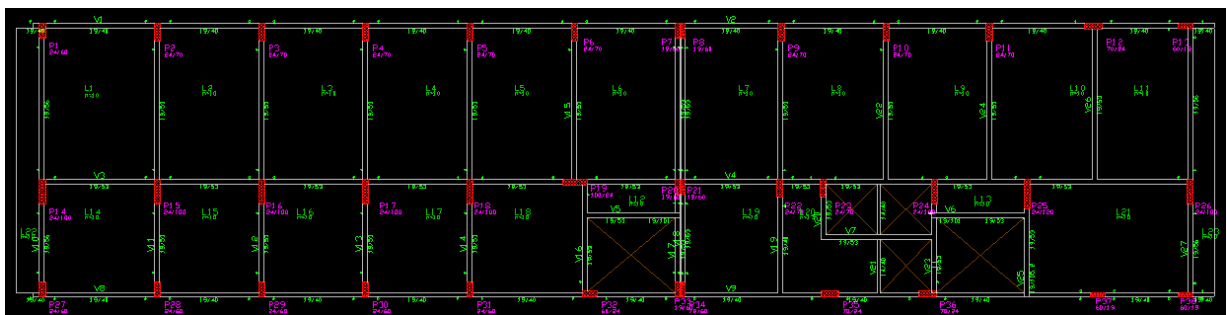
Pavimento tipo com lajes, vigas e pilares pré-dimensionados no modelador do TQS (Fonte: Autor, 2023)
